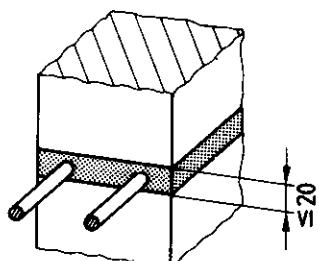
Horizontale Bewehrung in der Lagerfuge (Prinzipskizze)
